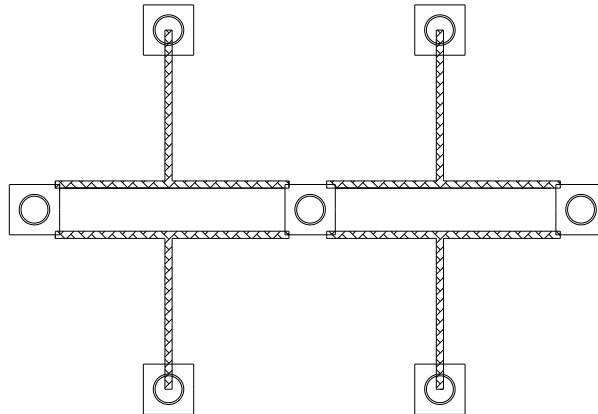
Configuración de 4 aisladores por pares de muros.
